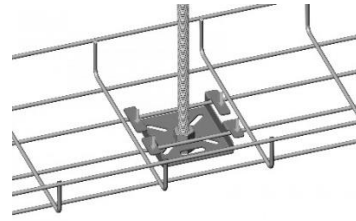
Пластина монтажная универсальная ЛМПРО ПжТехКабель
